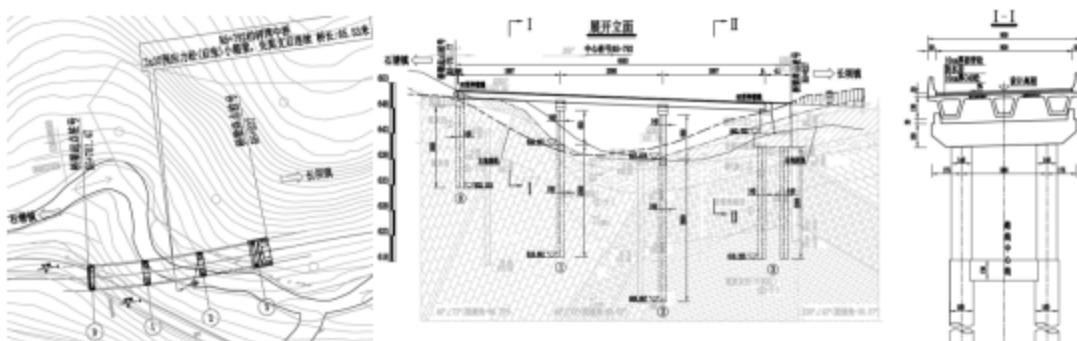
K6+800柏树湾中桥桥位、桥型平面布置图
